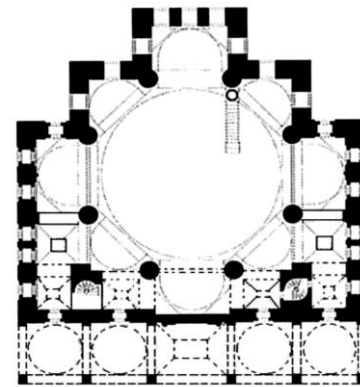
المسقط الأفقي لجامع مسيح محمد باشا عن:
